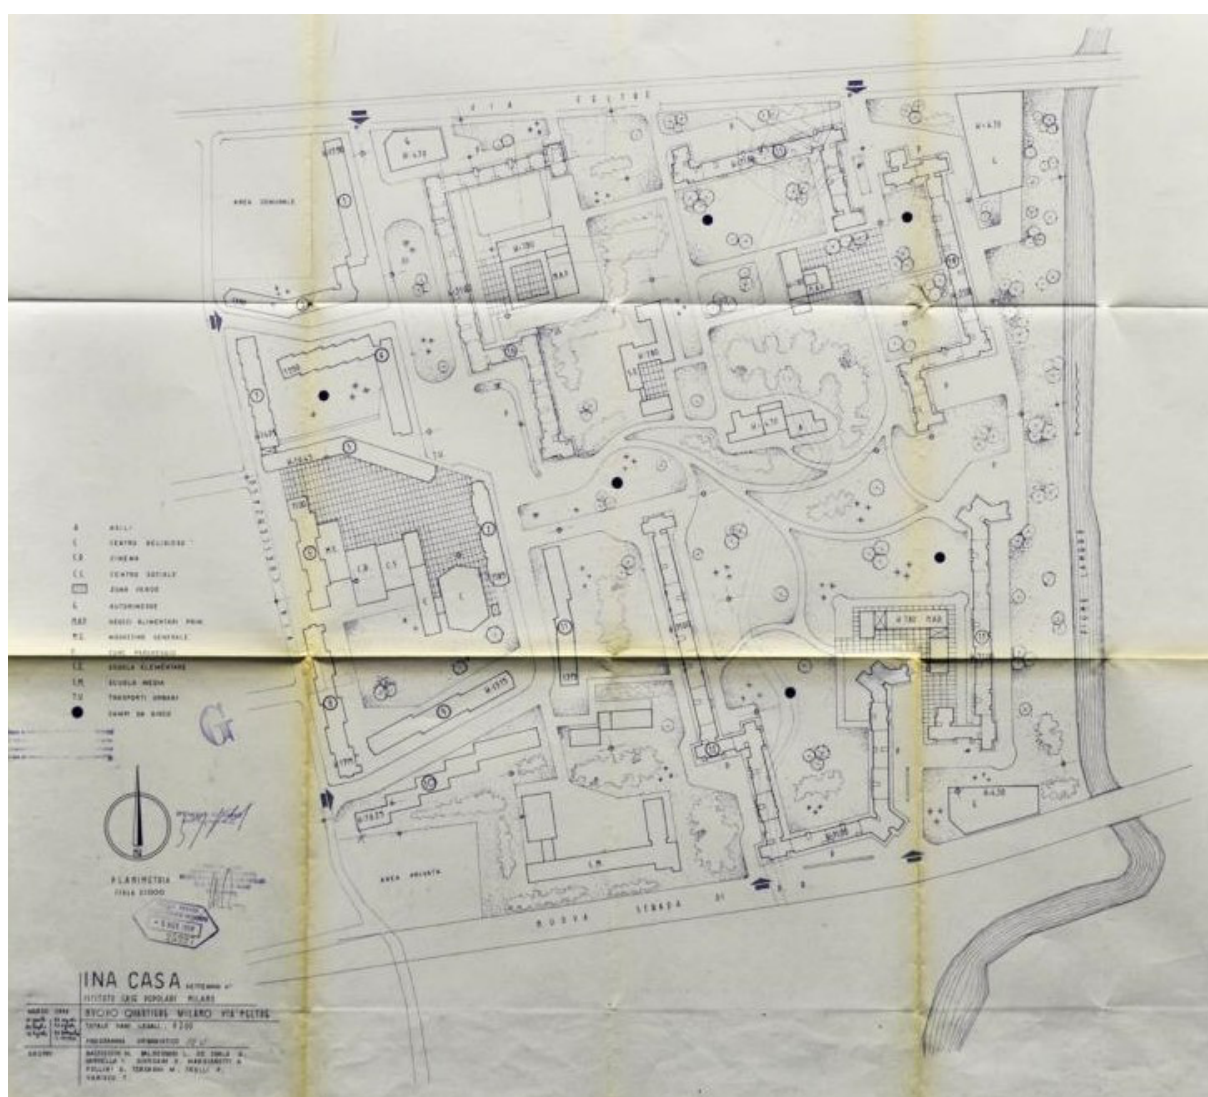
| Planimetria generale di progetto. Fonte: Archivio Civico Milano.
